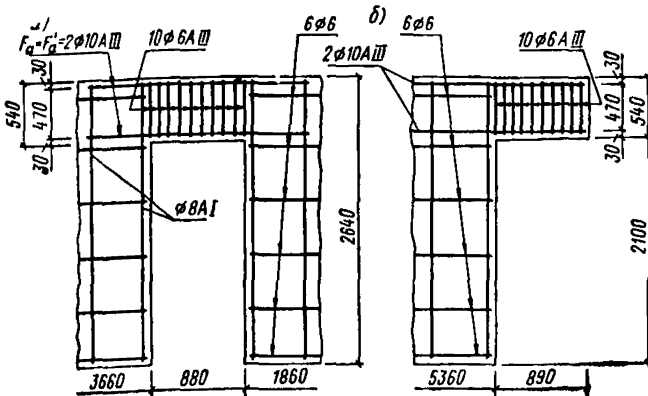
Соединение стен с помощью перекрытия при наличии проема вблизи стыка
